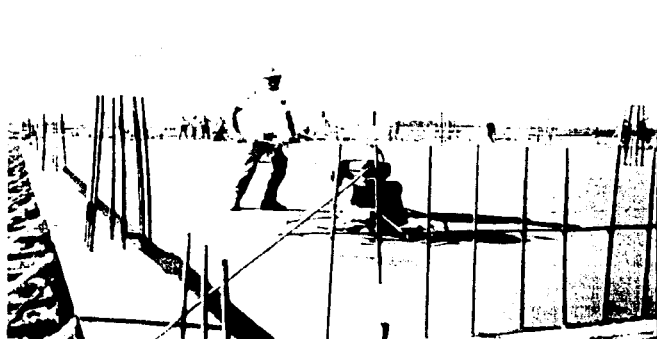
Flotado de concreto con allanadora con discos de flotado
